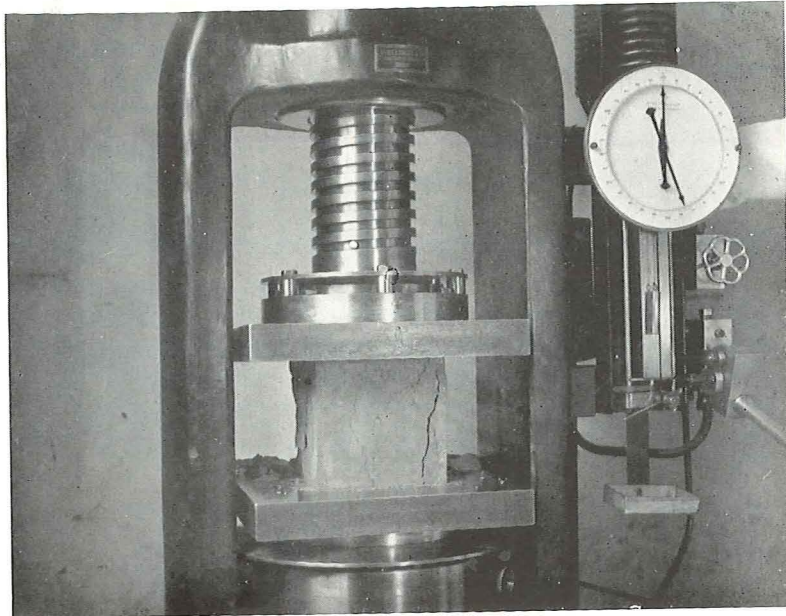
Hydraulisk presse til bestemmelse af betons trykstyrke.
